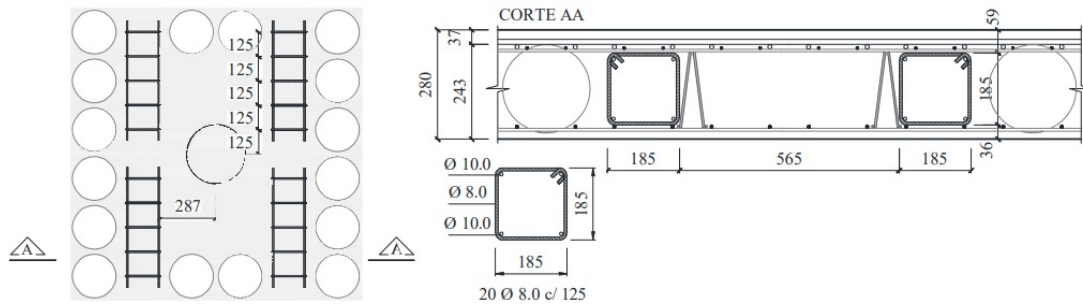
Armadura de cisalhamento das lajes BD1 e BD2 (dimensões em mm) (fonte: Nicácio (2018))
